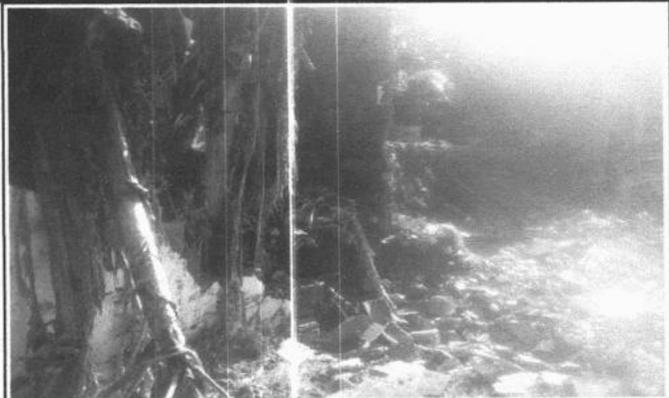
RECONSTRUÇÃO DE MURO TOMBADO
